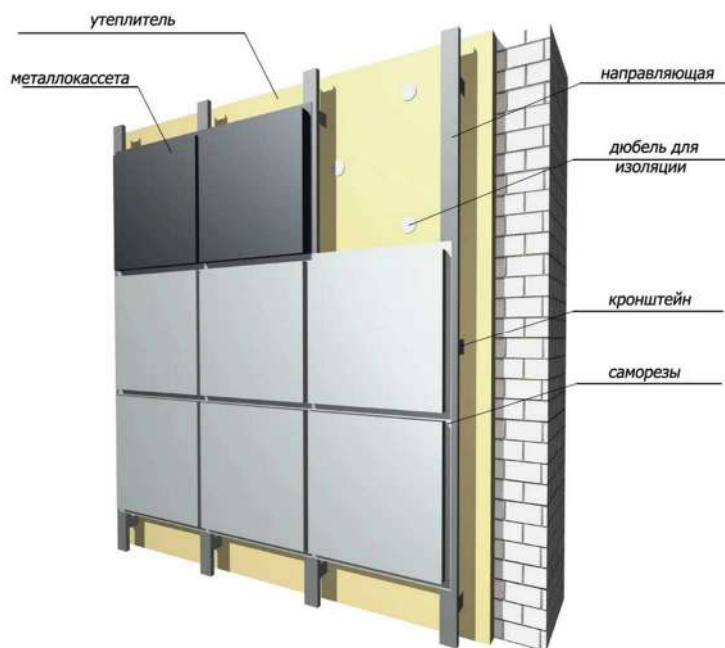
Конструктивное решение навесного вентилируемого фасада с металлокассетами
